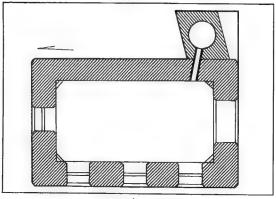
مسقط أفقي لسبيل بثر أم القرون.
